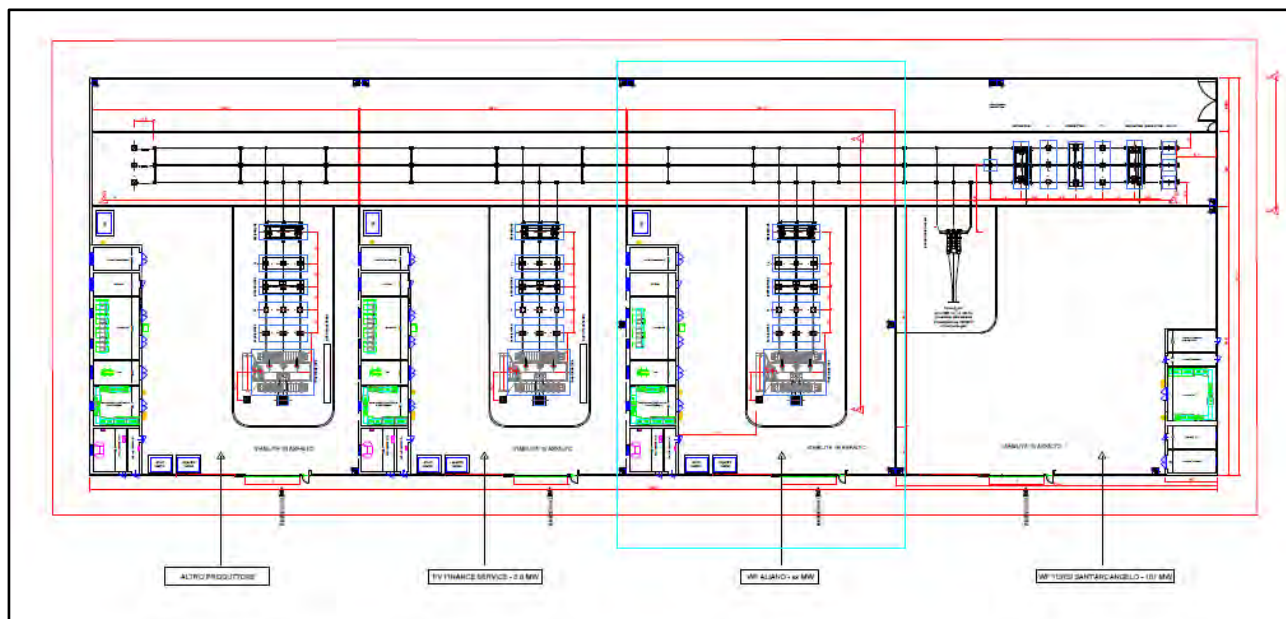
Planimetria elettromeccanica della Sottostazione elettrica condivisa
